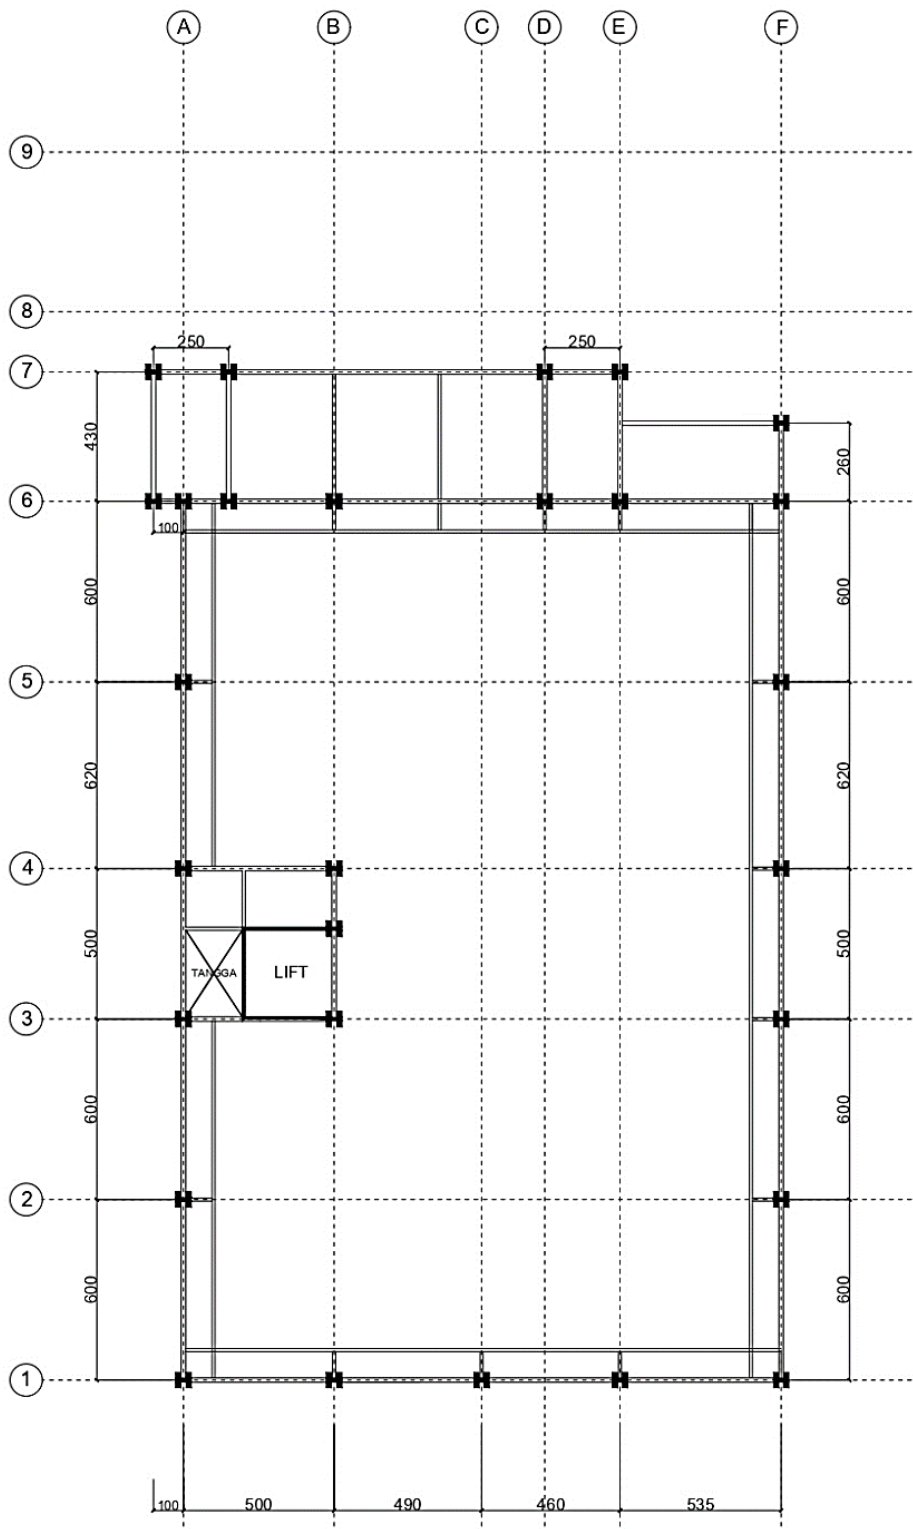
Gambar Denah Sloof dan Kolom Lantai 2
